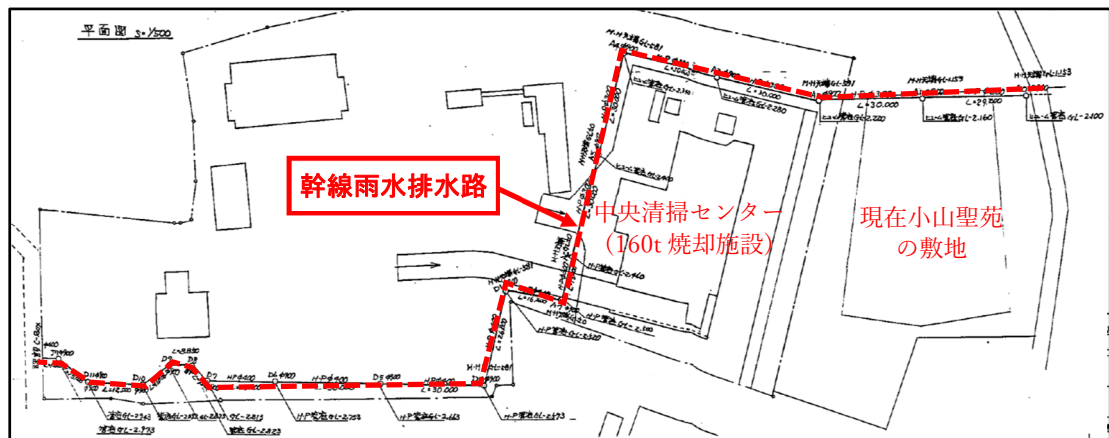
幹線雨水排水路の配置図 (160t 焼却施設整備時)
